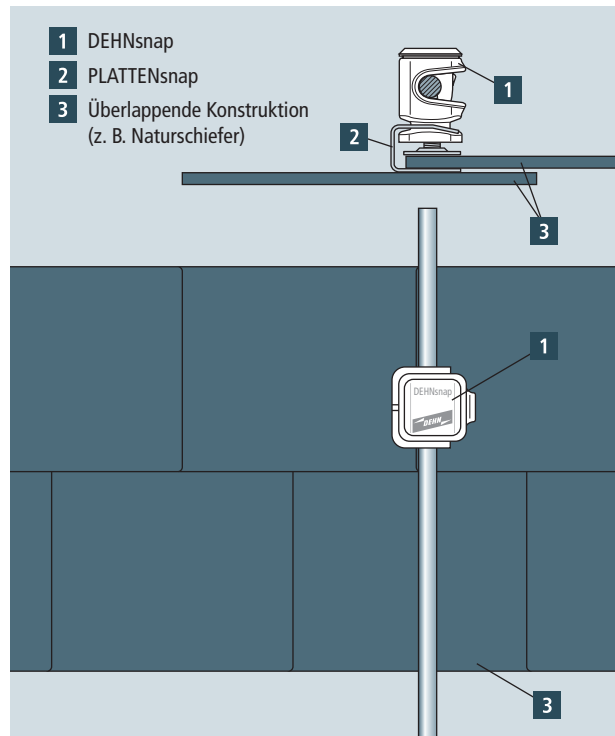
Dachleitungshalter PLATTENsnap für überlappende Konstruktionen
